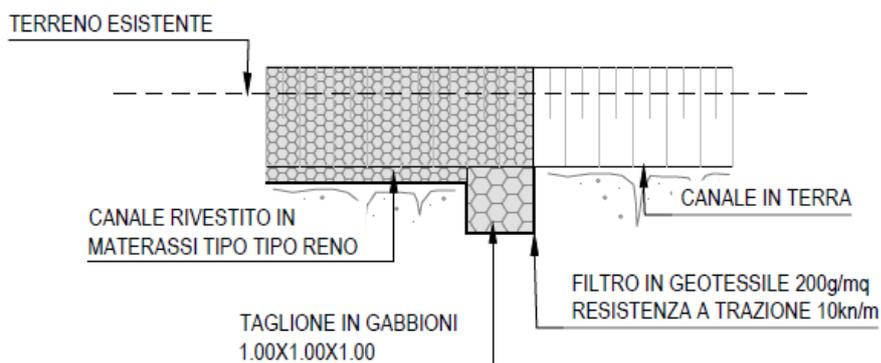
Dettaglio transizione canale in terra – canale rivestito
